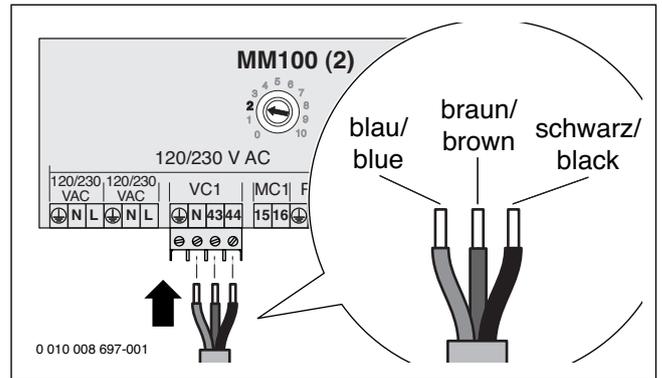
Anschluss Kabel Mischermotor am Modul MM100 [2]
